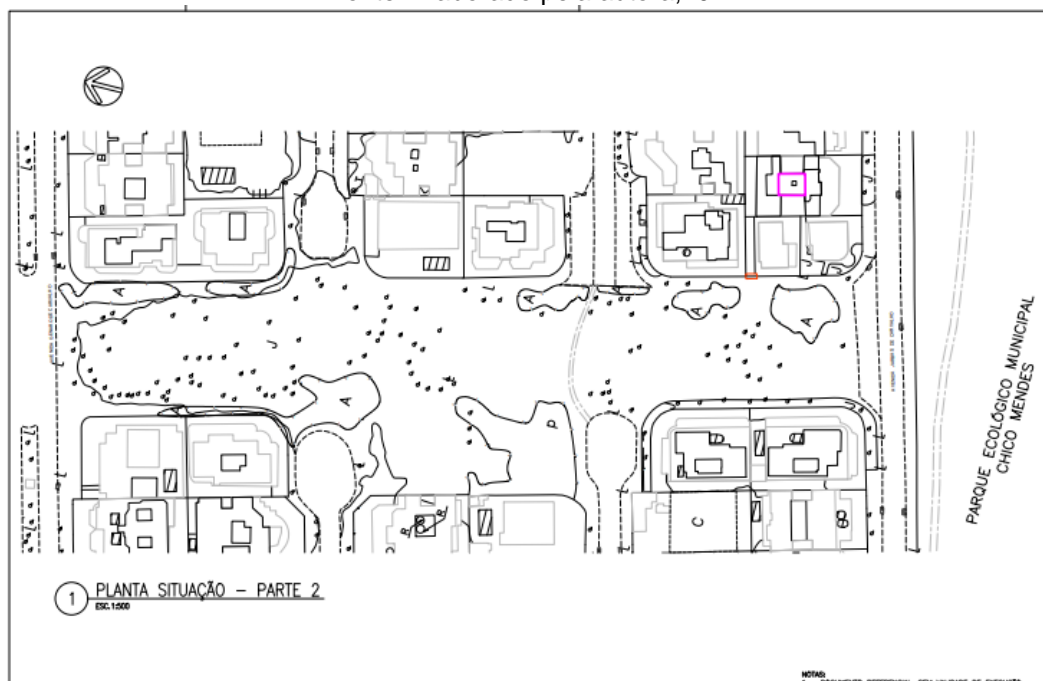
Planta de situação da Alameda Sandra P. de Faria Alvim no Recreio, parte 2, AP4
